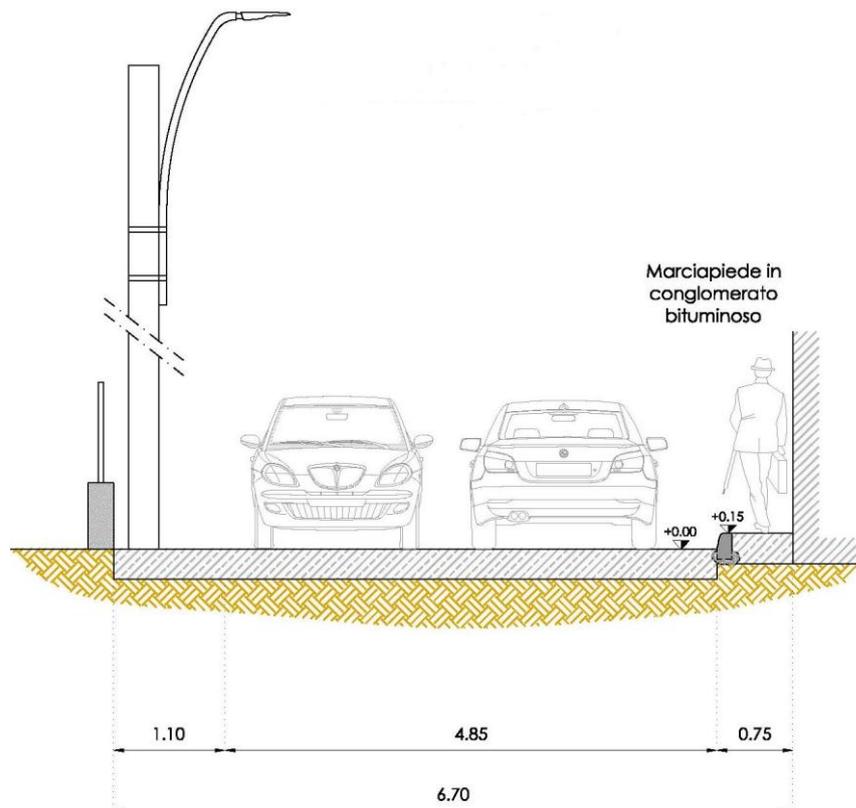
Sezione tipologica stato di fatto – strada Castelletto
